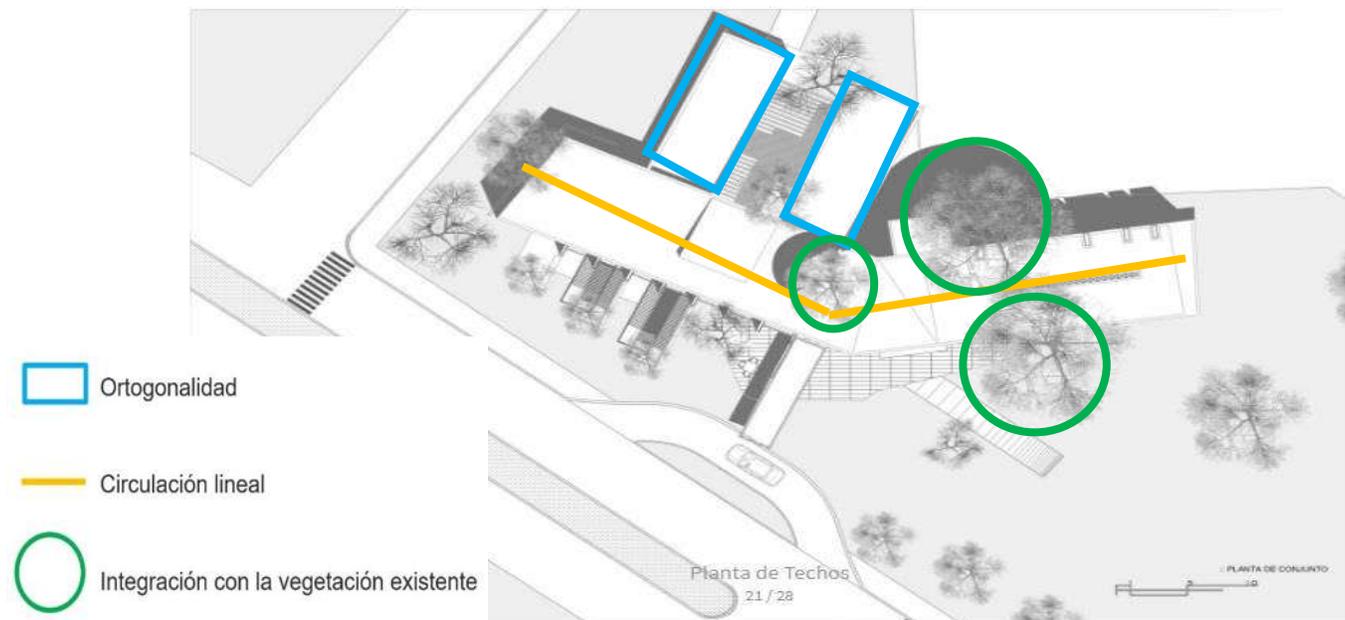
Planta de Techos Casa del Abuelo. Fuente: www.archdaily.mx/mx
